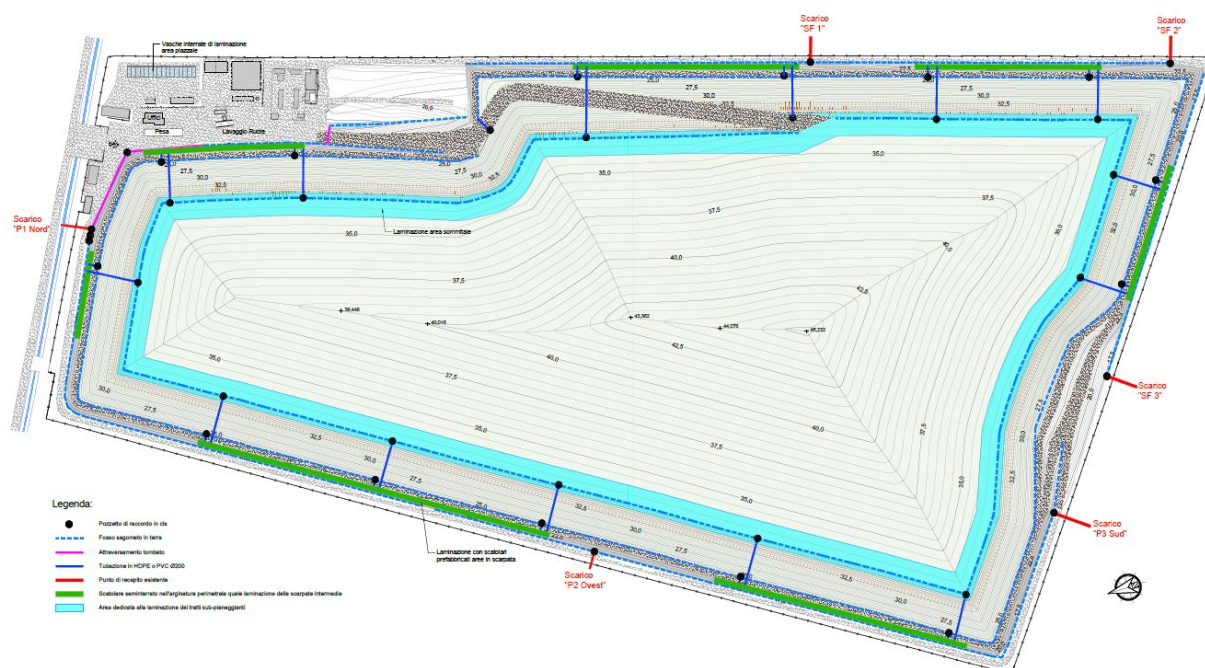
planimetria generale rete di raccolta acque meteoriche [Fonte: Tavola 6.1 del progetto]
